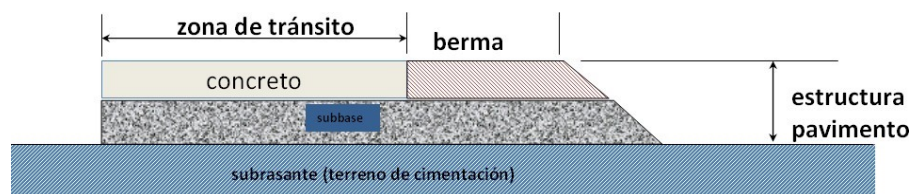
Esquema de un pavimento Rígido. Fuente: Becerra M, 2012
